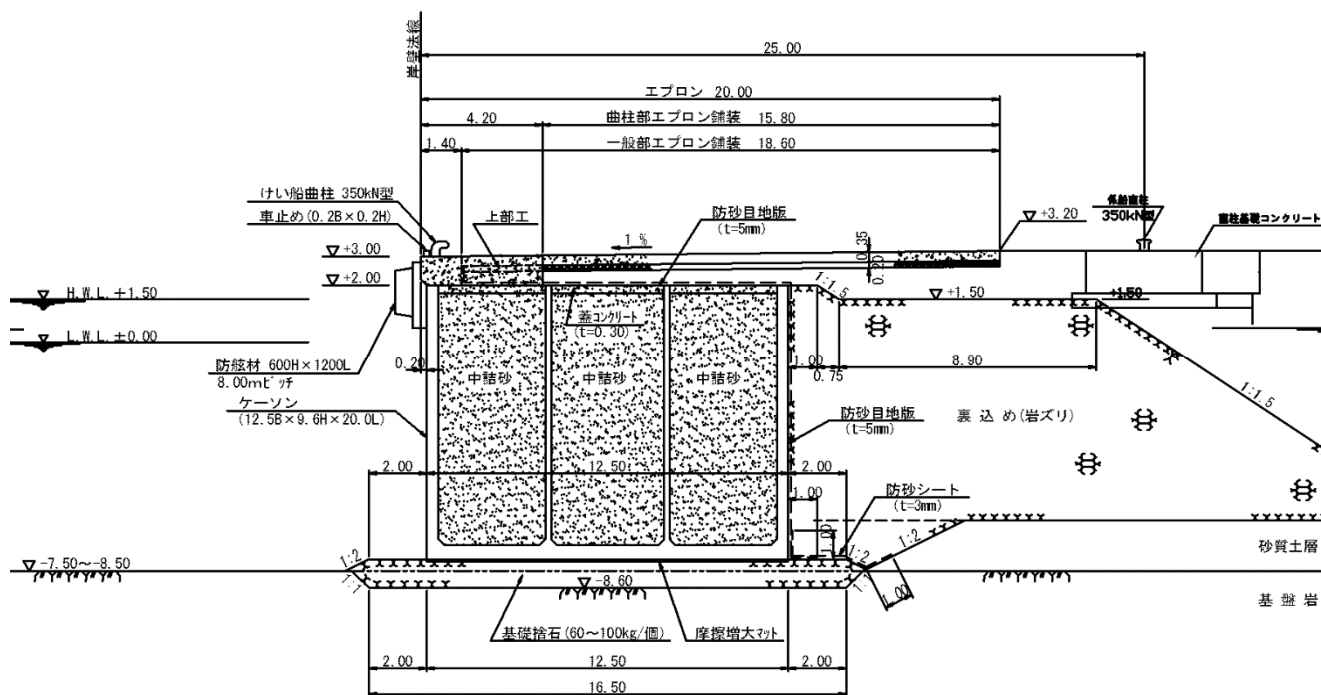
No.20 常陸那珂港区\_中央ふ頭地区岸壁 (-7.5m) の断面図 (被災前)
